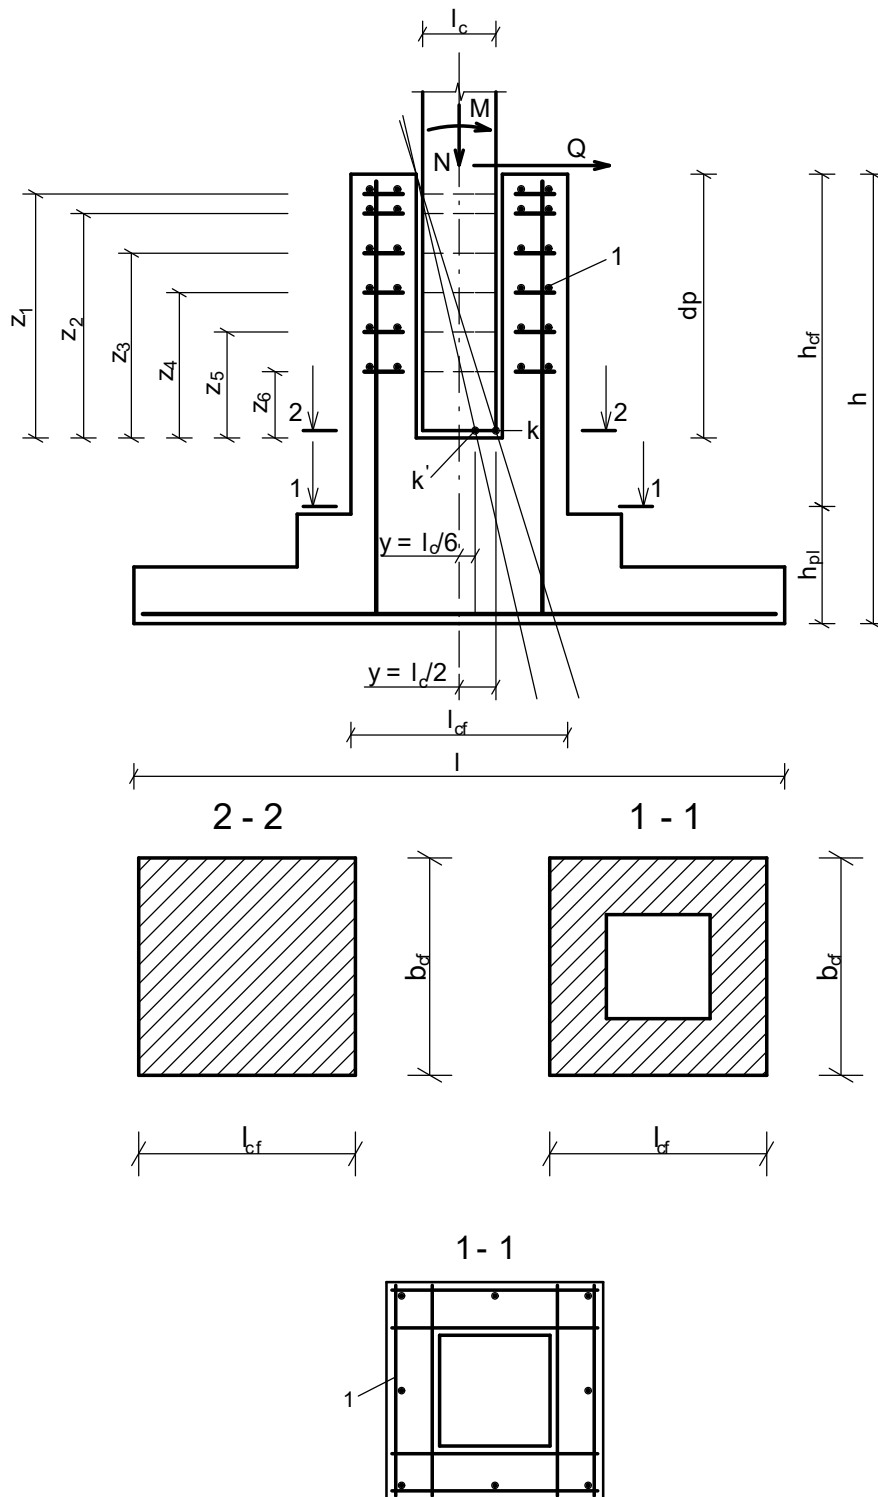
Розрахункові перерізи залізобетонних підколонників під збірні колони
